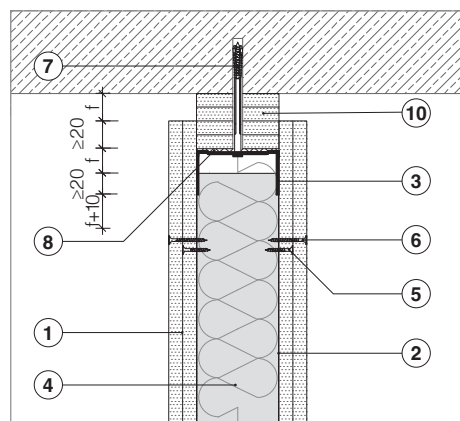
Conexiunea peretelui cu planșeu din beton armat, asigurarea unui rost glisant de până la 5cm
